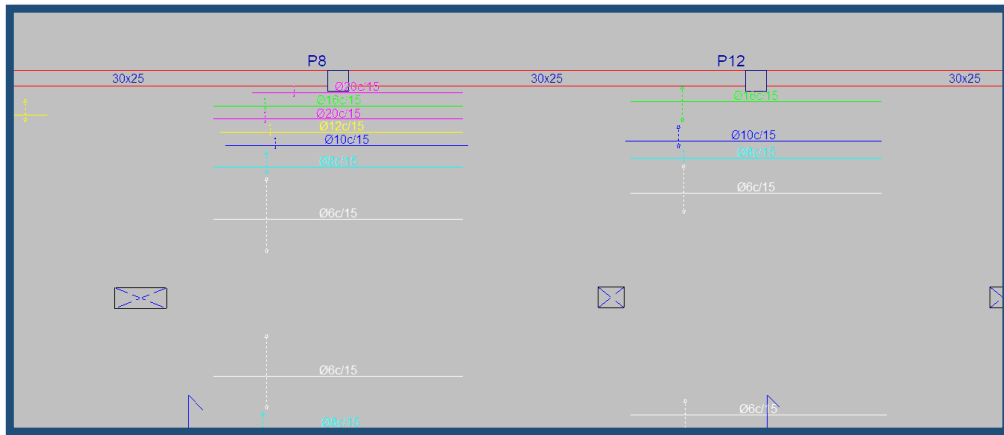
Necesidad de armadura de reparto en zonas de anclaje
